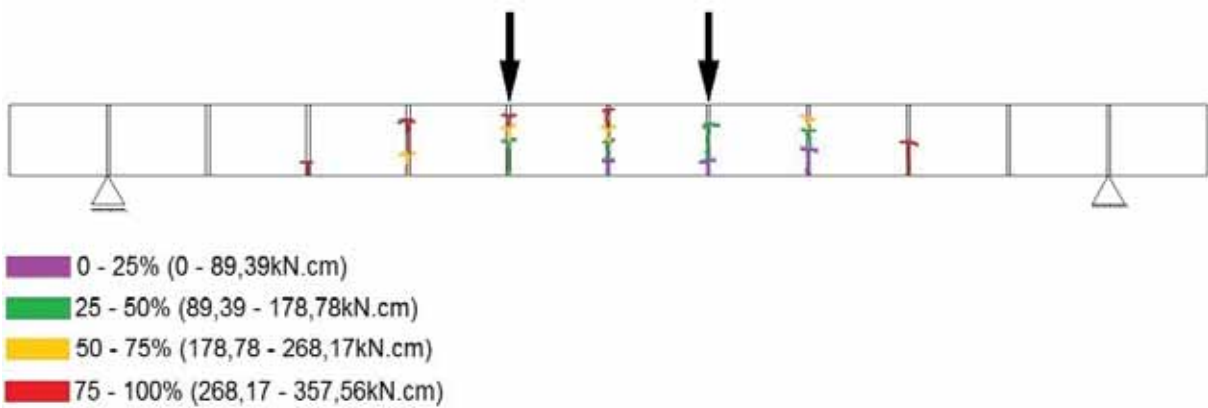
Histórico de fissuração das vigas canaletas
